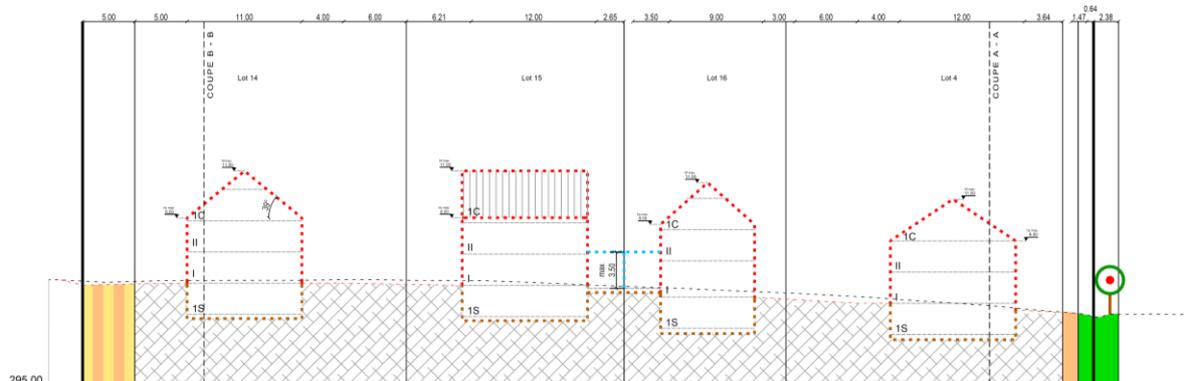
Coupe D-D du PAP. (Source : BEST)
